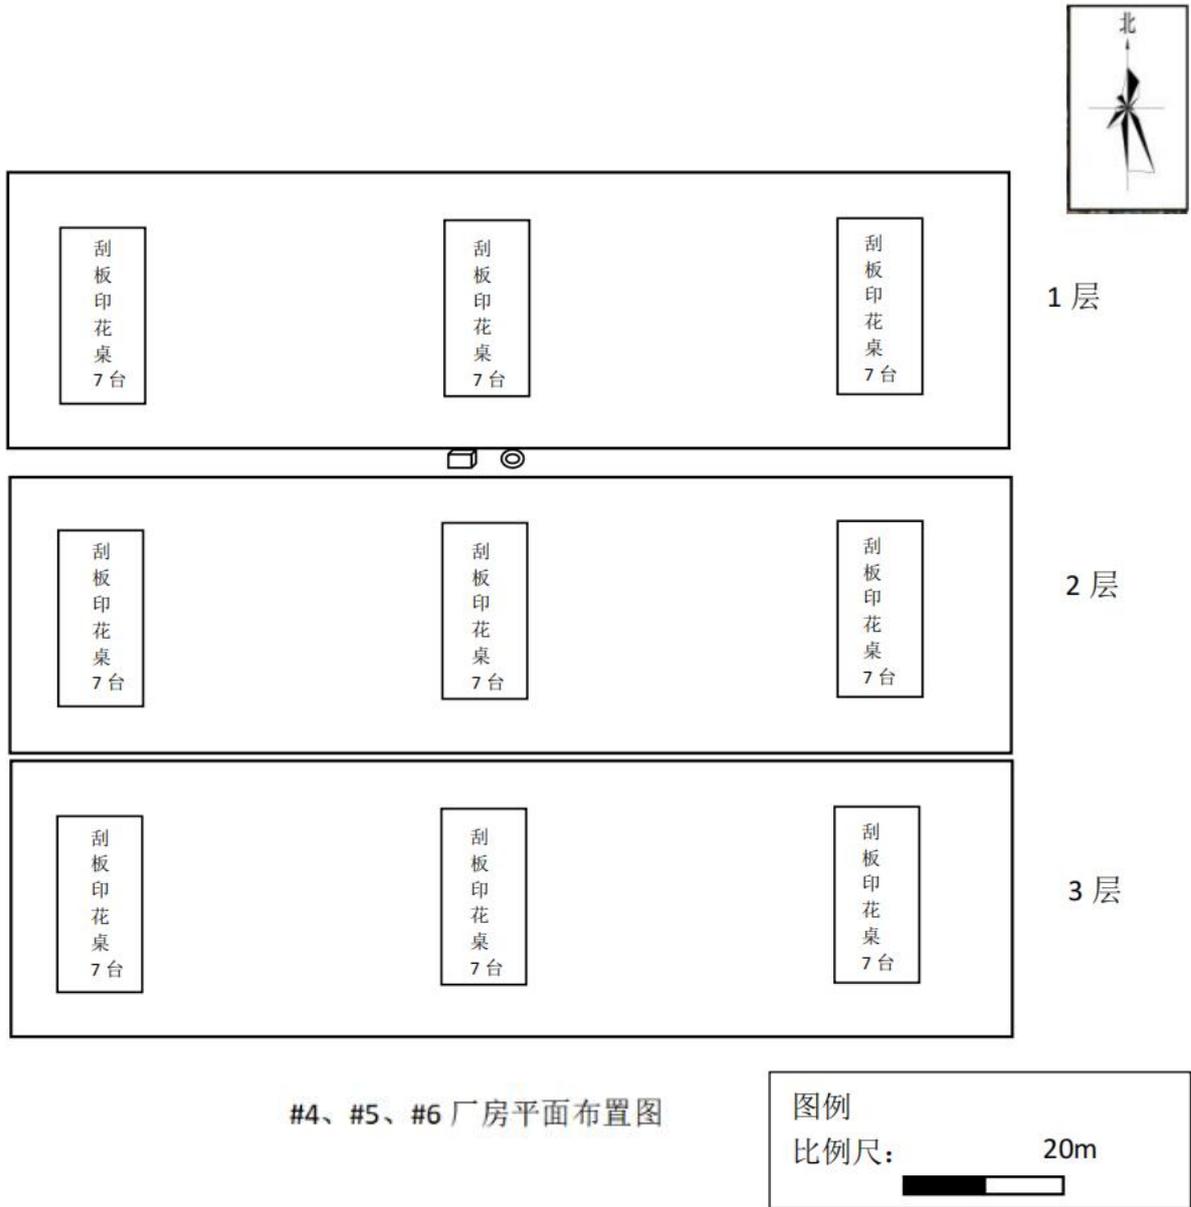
4#、5#、6#厂房平面布置图 (1:1000)
